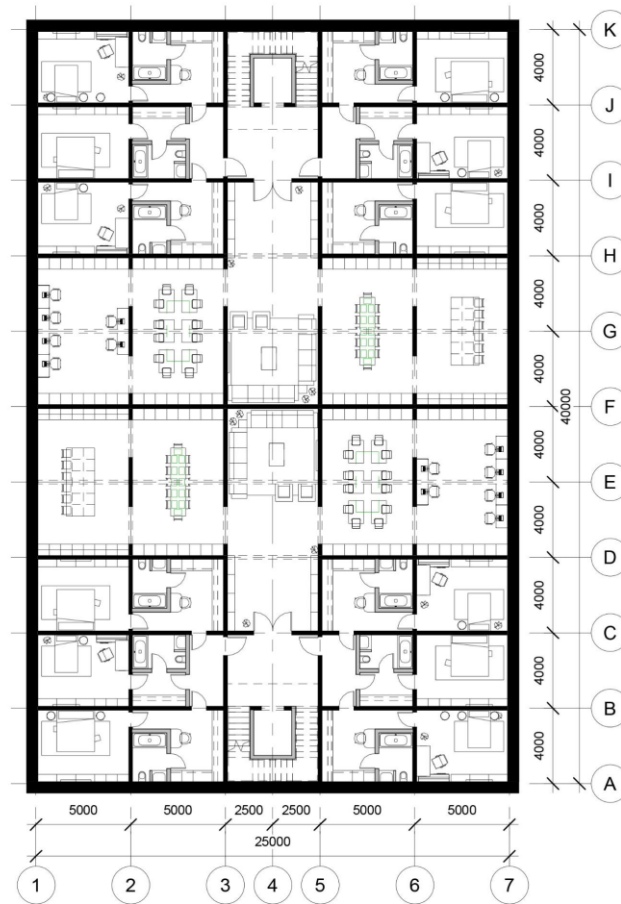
Edificio invernale – Planimetria di un piano tipo.
